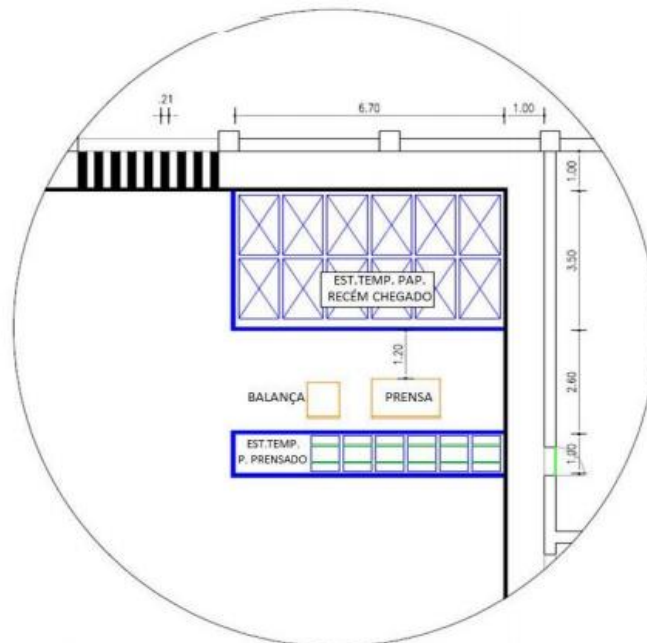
Planta baixa do galpão da COOBAFS com a indicação do local da intervenção
